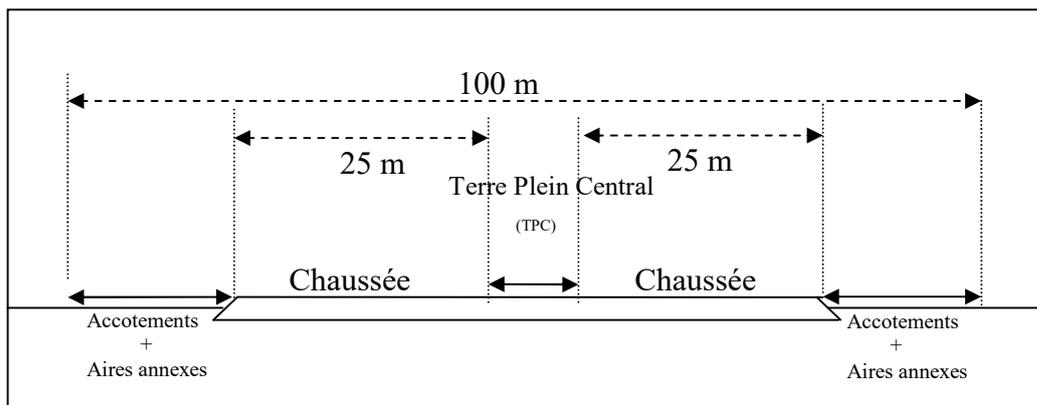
Croquis d'un profil en travers d'une autoroute à 2x4 voies
